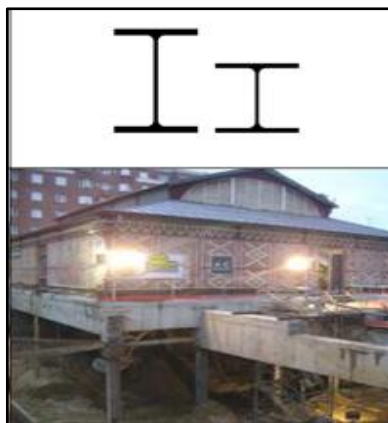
Profilés H pour pieux battus et poteaux préfondés
